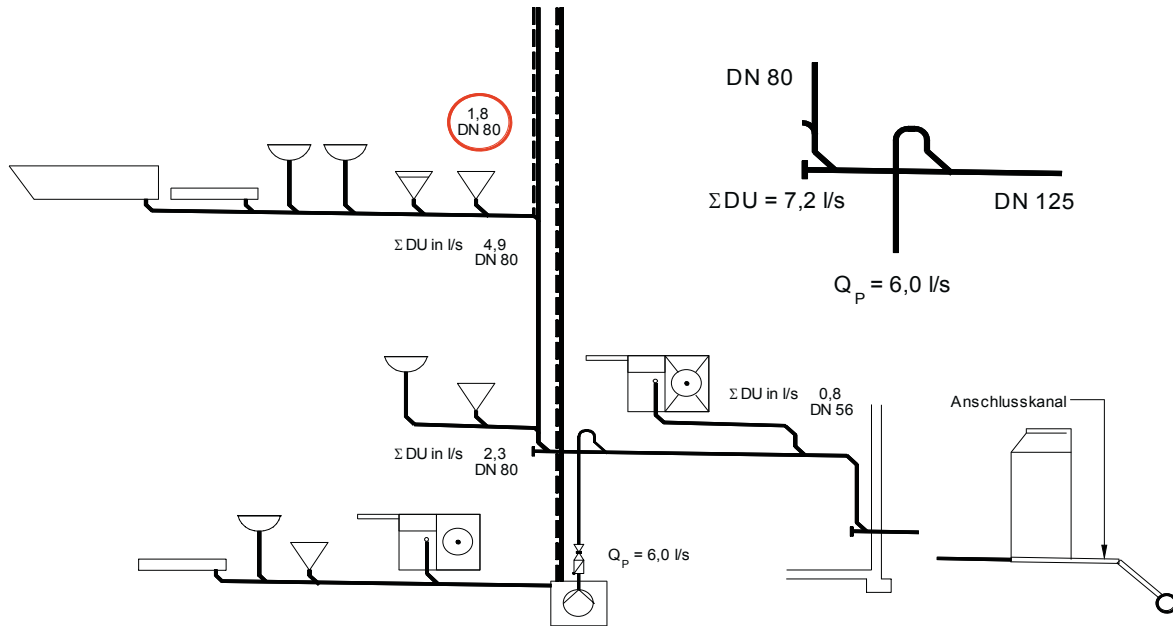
Bemessungsbeispiel: Einfamilienhaus mit Keller und Abwasserhebeanlage
